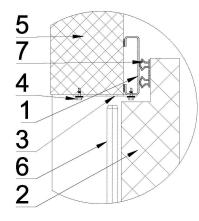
Узел Крепление декоративны пластин на отверстия для верхнего и нижнего шпингалета
